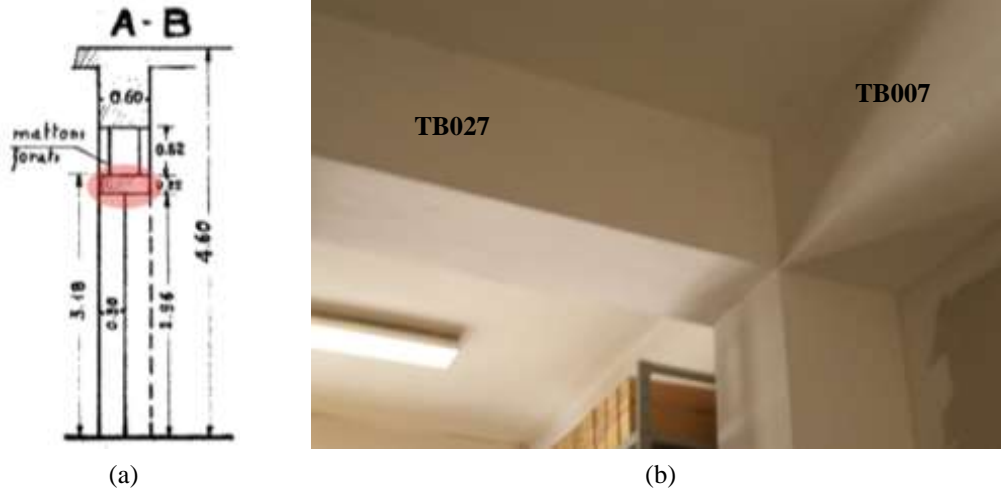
(a) Elementi orizzontali lato corridoio al piano 3° (stralcio della tavola del progetto preliminare); (b) vista delle travi interne al piano terra soggette a rilievo materico-strutturale.
